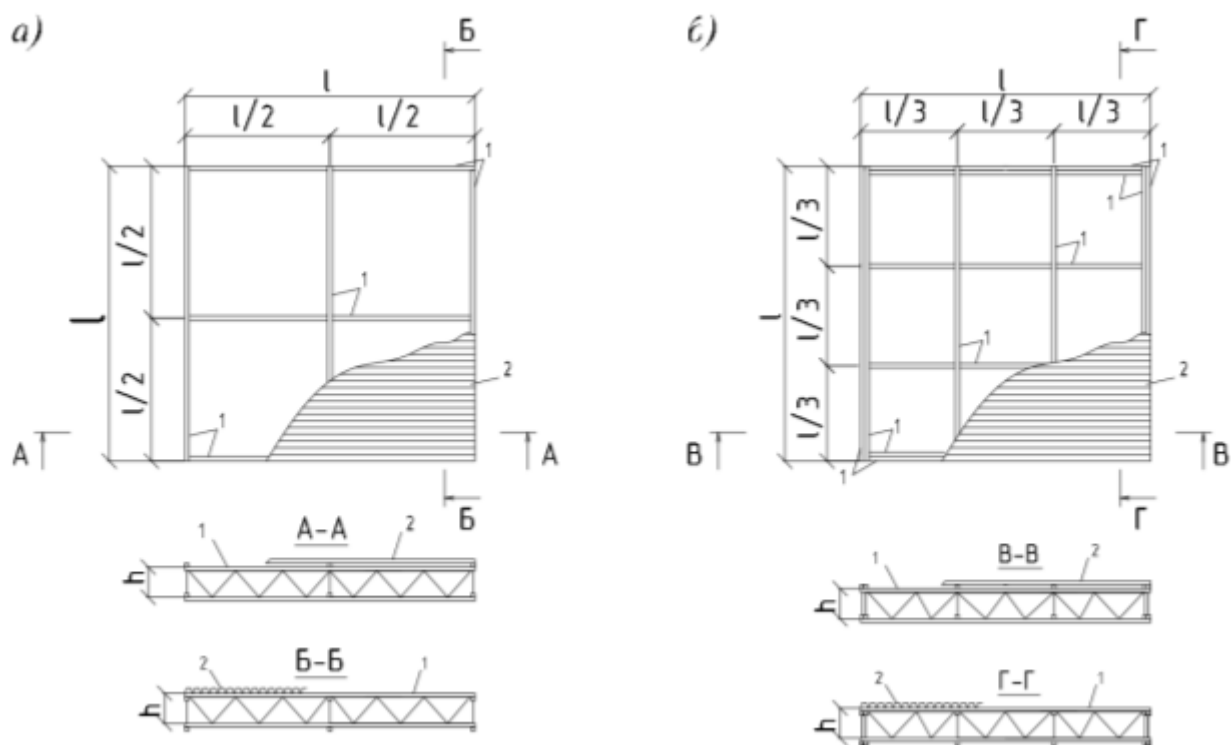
Схемы модуля «Пятигорск» из перекрестных ферм при количестве ячеек 2×2 (а) и 3×3 (б): 1 – одиночные перекрестные фермы; 2 – элементы ограждения (профилированные листы) [3]
